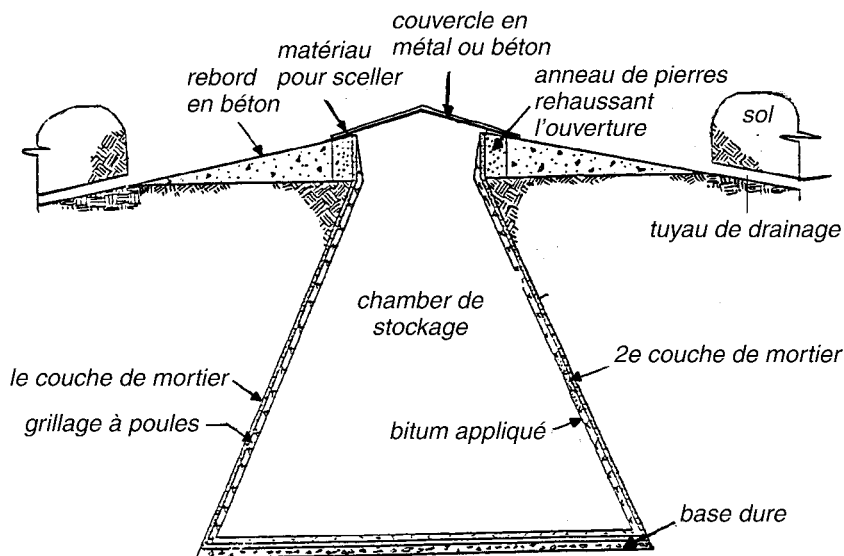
puits souterrain amélioré, revêtu de ciment armé (coupe transversale)
